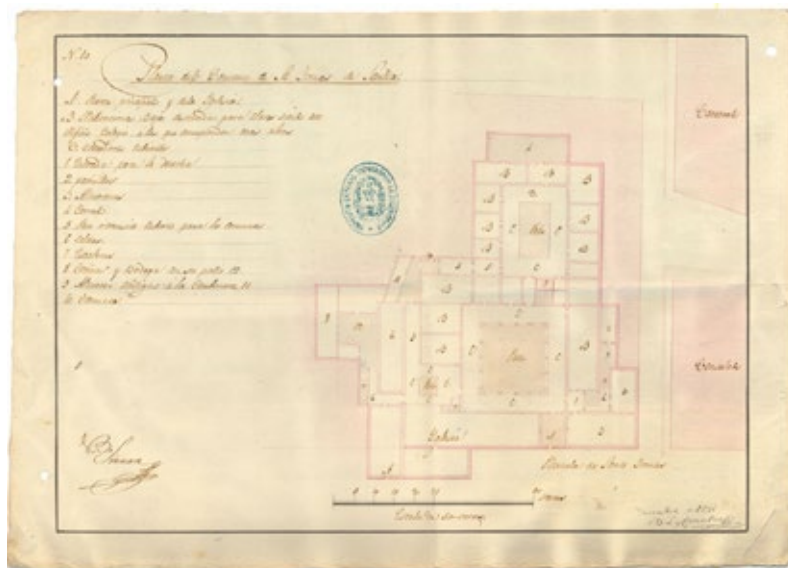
Planta del convento de Santo Tomás de Sevilla. B. León y Canales. 1835 (AGMM)
